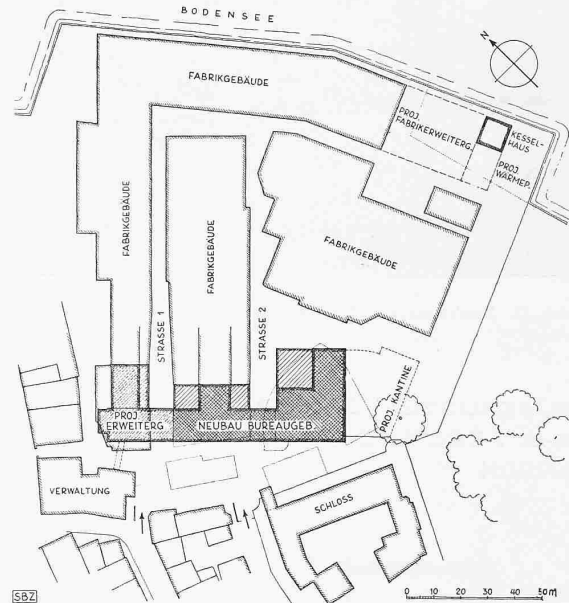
Lageplan des neuen Bureaugebäudes. — 1 : 2500
